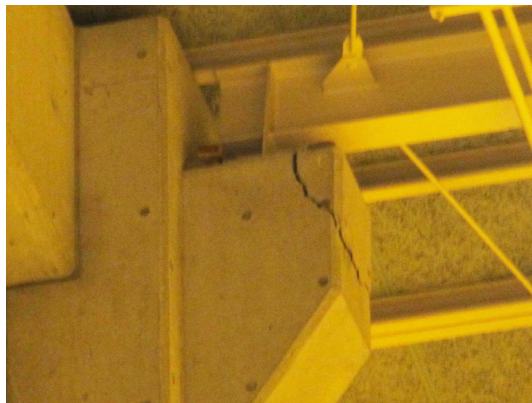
支承部のコンクリートのひび割れ
